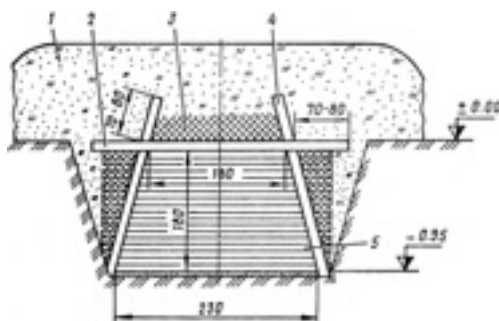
Быстровозводимое убежище на 20 чел. из железобетонных перемычек: 1 – насыпной грунт; 2 – перемычка 1ПР4-33.12.22; 3 – утрамбованный грунт; 4 – перемычка 1ПР3-24.12.14; 5 – перемычка 1ПР3-24.12.14
